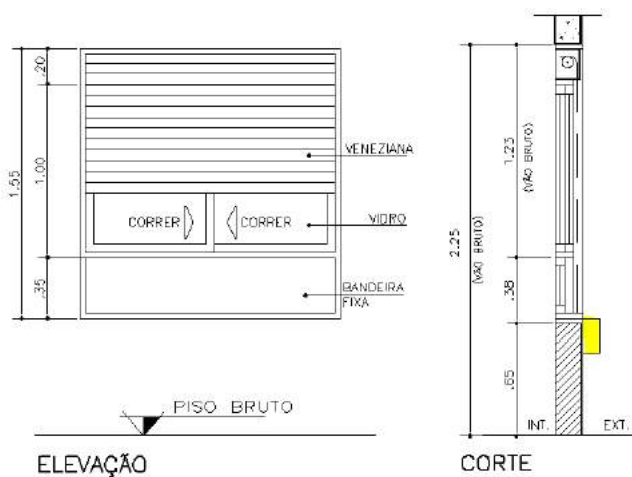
Elemento de EPS na fachada – Detalhamento de arquitetura
